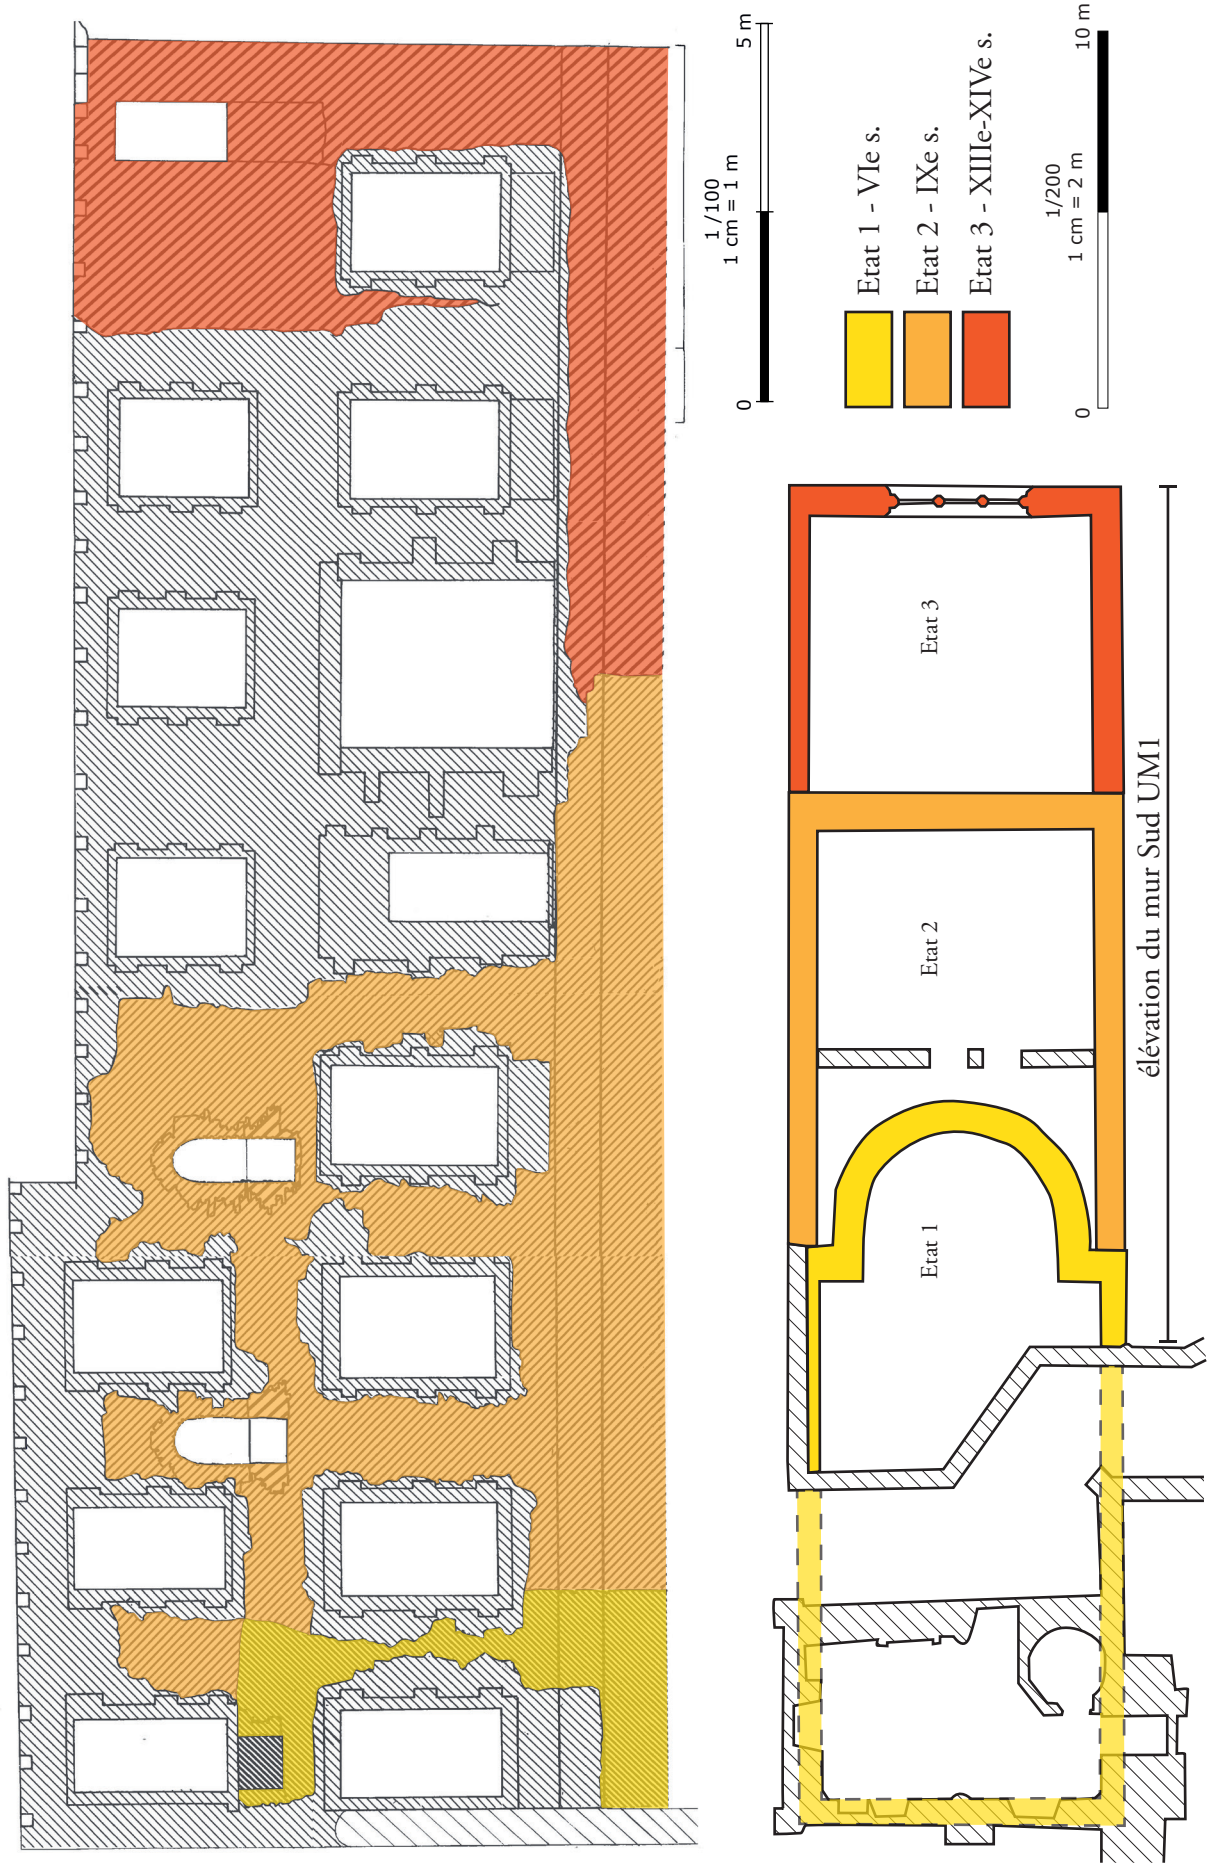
Synthèse chronologique de l'étude Monique JANNET-VALLAT. Plan et élévation du mur sud, éch. : 1/100^e (élévation) et 1/200^e (plan) Source : Jannet-Vallat 1987, Planche n°70 & plan d'ensemble VII ; DAO : Q. Rochet
